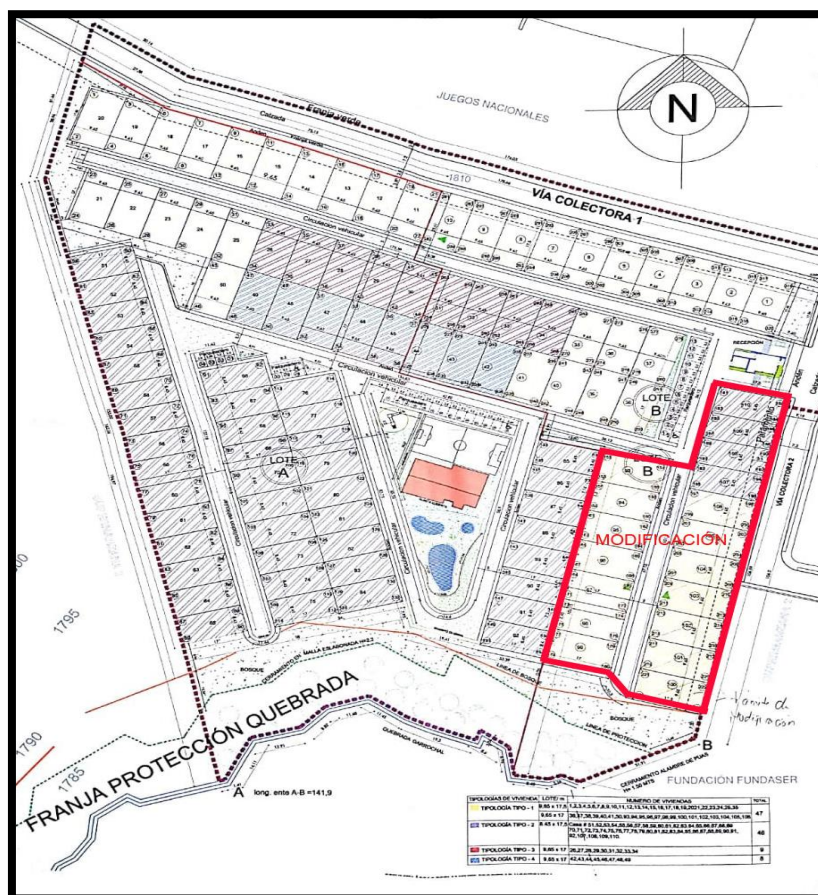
Modificación de la licencia de construcción en cuanto a la tipología de las viviendas en la segunda etapa de construcción, fuente propia.
